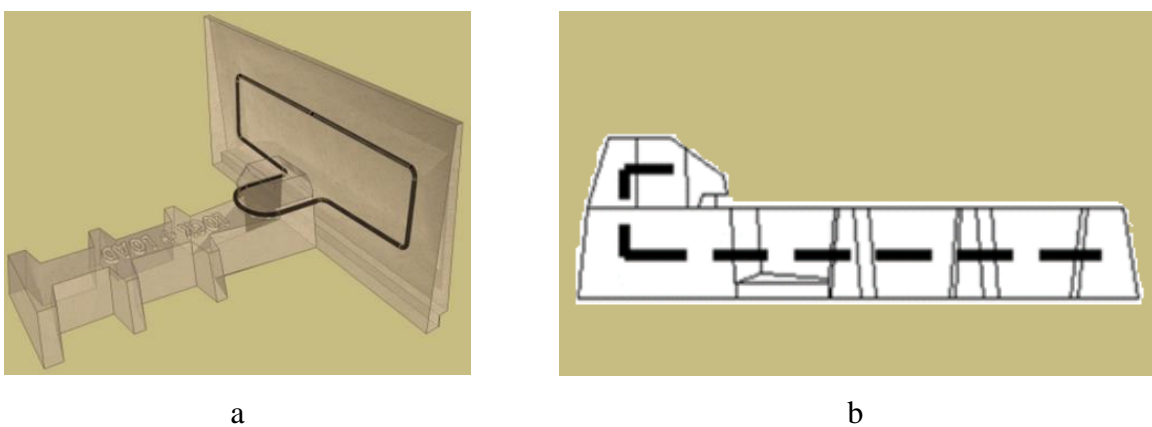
Posicionamento da armadura no painel (a) e vista armadura no contraforte (b).
